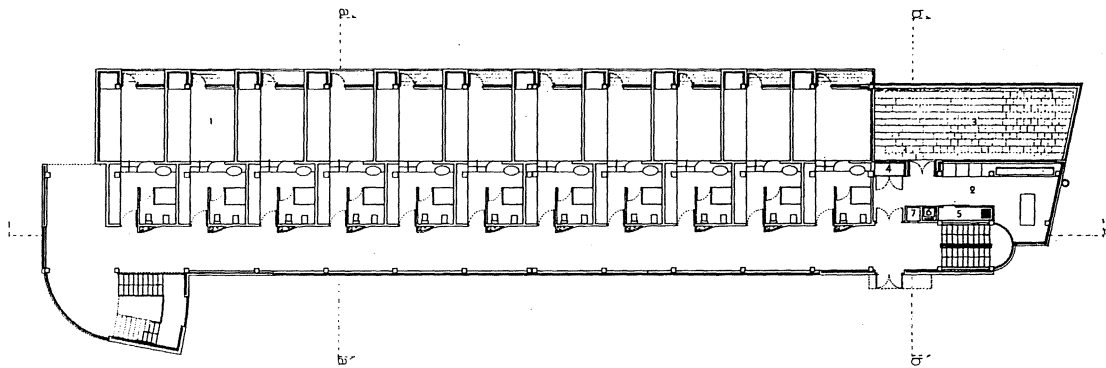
RESIDENCIA: PLANTA PRIMERA.
